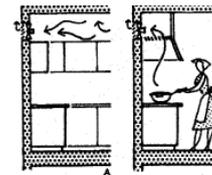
Ventilation avec ventilateur sur mur extérieur.
